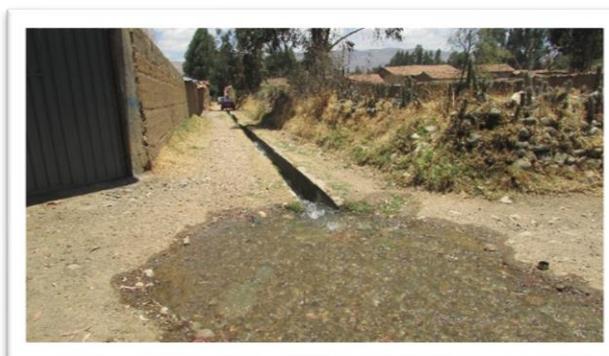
Calle Arequipa, tramo no asfaltado rumbo al Cementerio de Apata.
